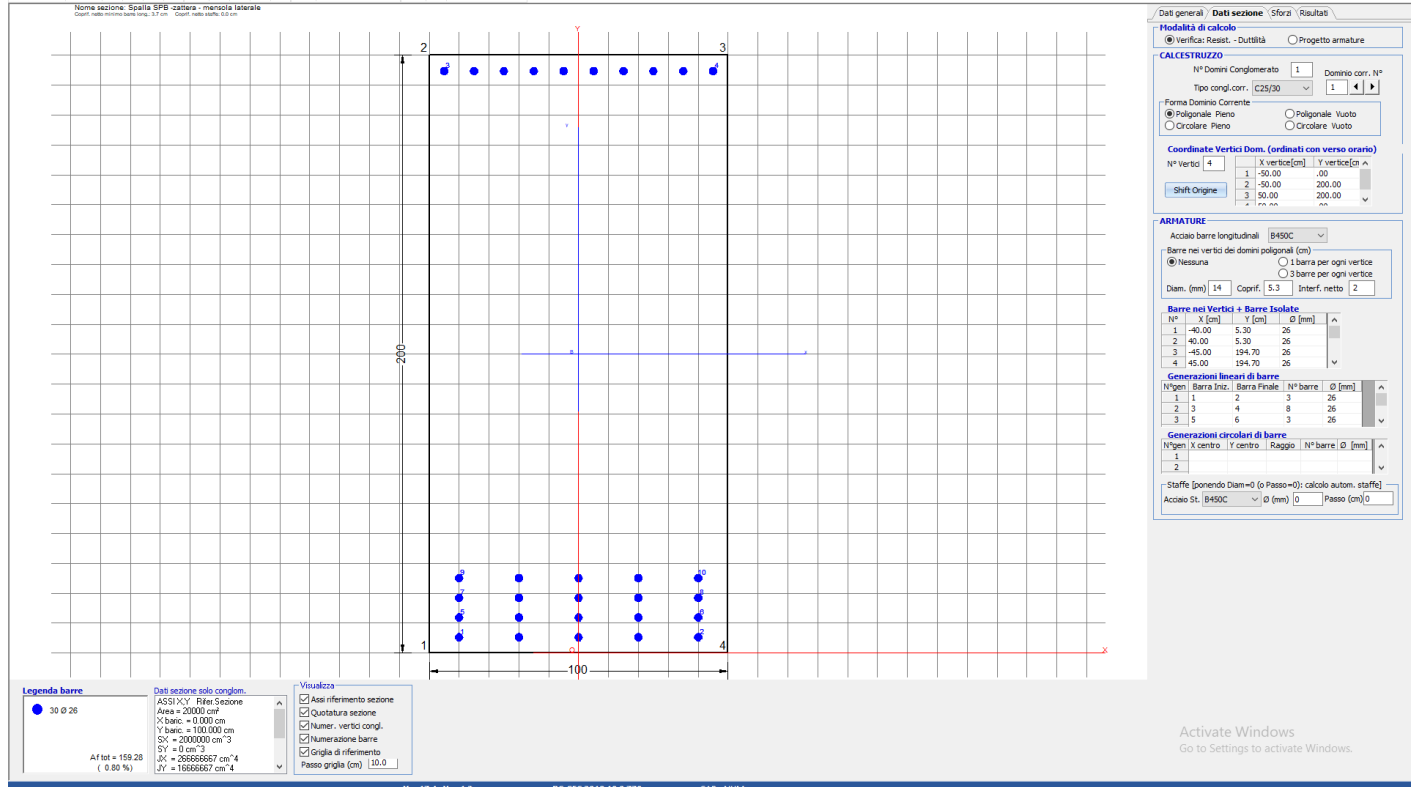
Plinto di fondazione – Mensola laterale - Geometria sezione di verifica
